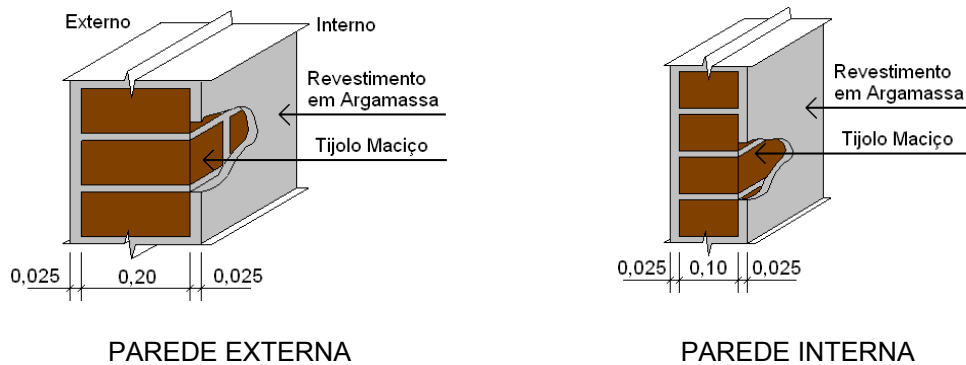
Detalhe construtivo das alvenarias externa e interna - Edificação 6
